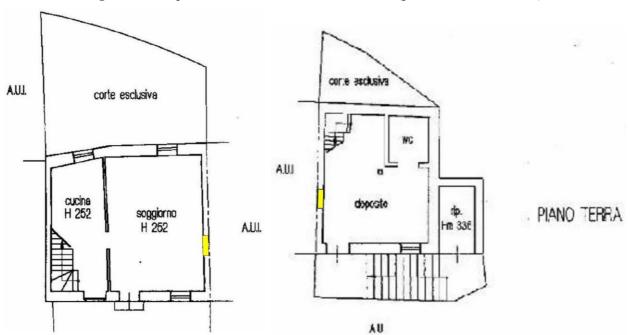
Comparazione stato attuale – stato rilevato (planimetrie non in scala)
